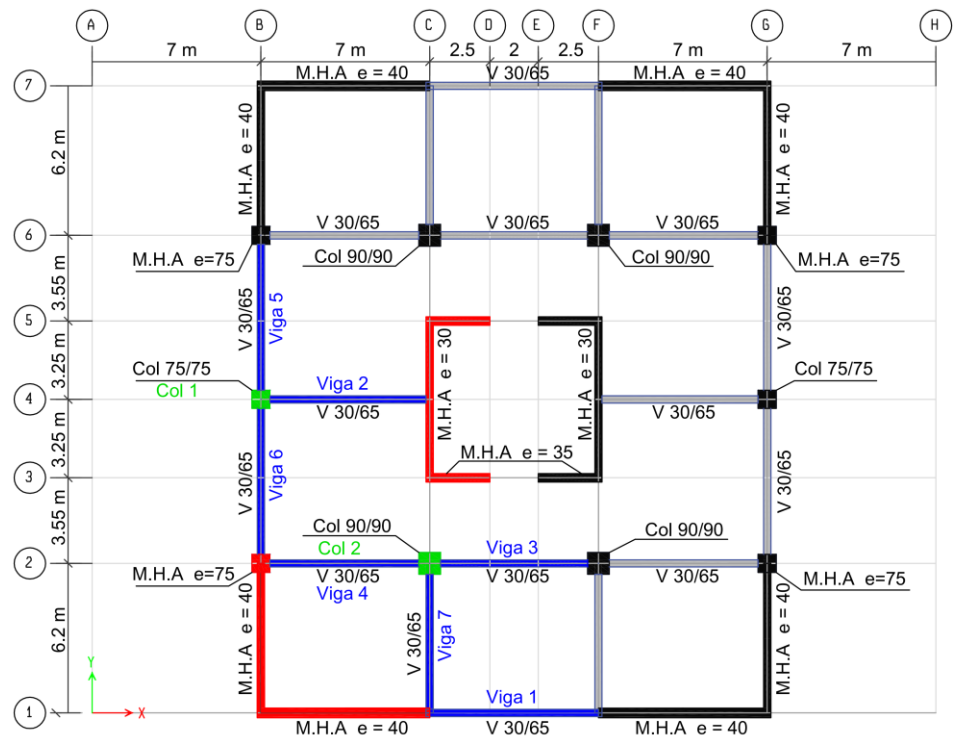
Planta pisos 6 a 20, elementos estructurales definidos.
